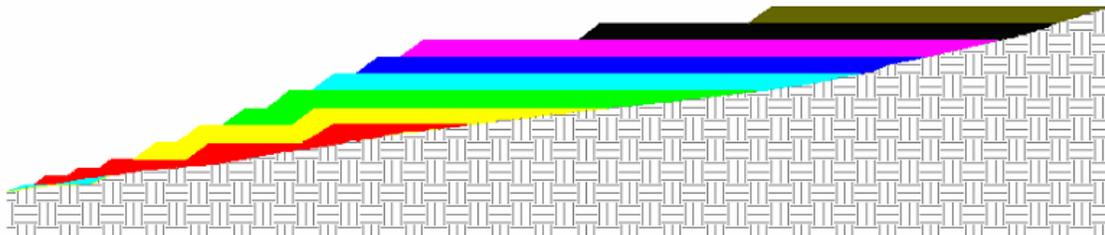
Sección Longitudinal Típica del Depósito de Lixiviación.
